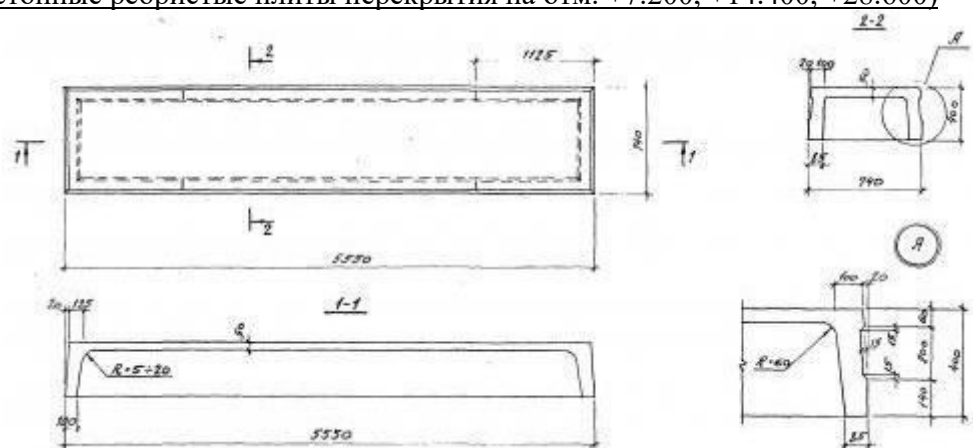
Ребристая плита перекрытия габаритами 0.74x5.55x0.4
